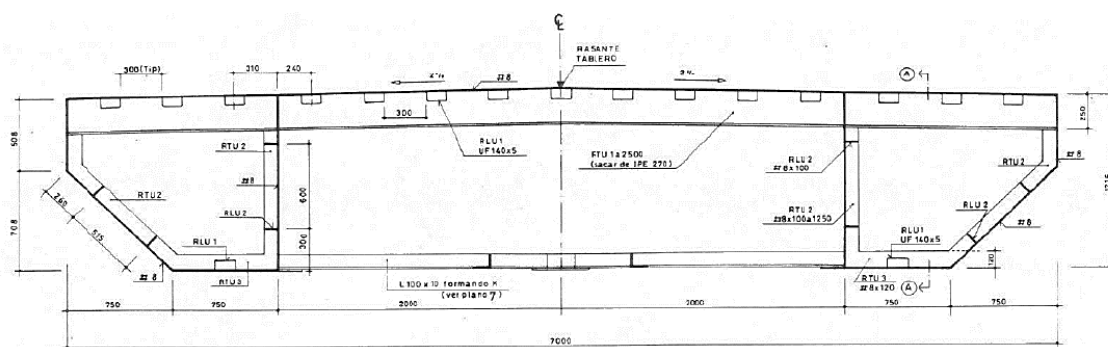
Plano de sección transversal tipo. (Fuente: Proyecto de construcción original).
